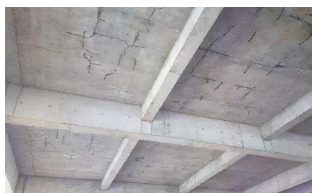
某工程钢筋混凝土楼板板底裂缝开展
